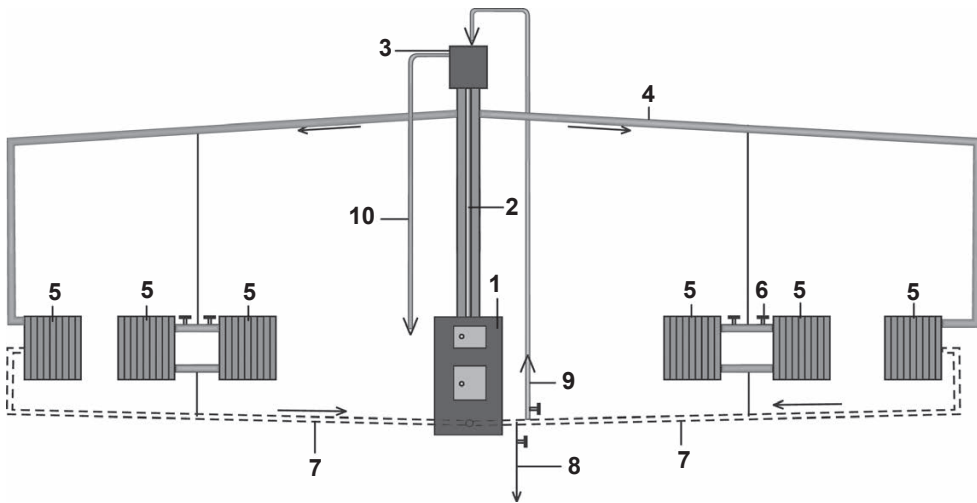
Схема двухтрубной системы отопления: 1 — котел; 2 — главный стояк; 3 — расширительный бачок; 4 — разводящая линия горячей воды; 5 — нагревательные приборы; 6 — кран двойной регулировки; 7 — обратная линия; 8 — вентиль с патрубком для спуска воды из системы; 9 — подпитка системы из водопровода или от ручного насоса; 10 — переливная линия (стрелками показан уклон труб)
